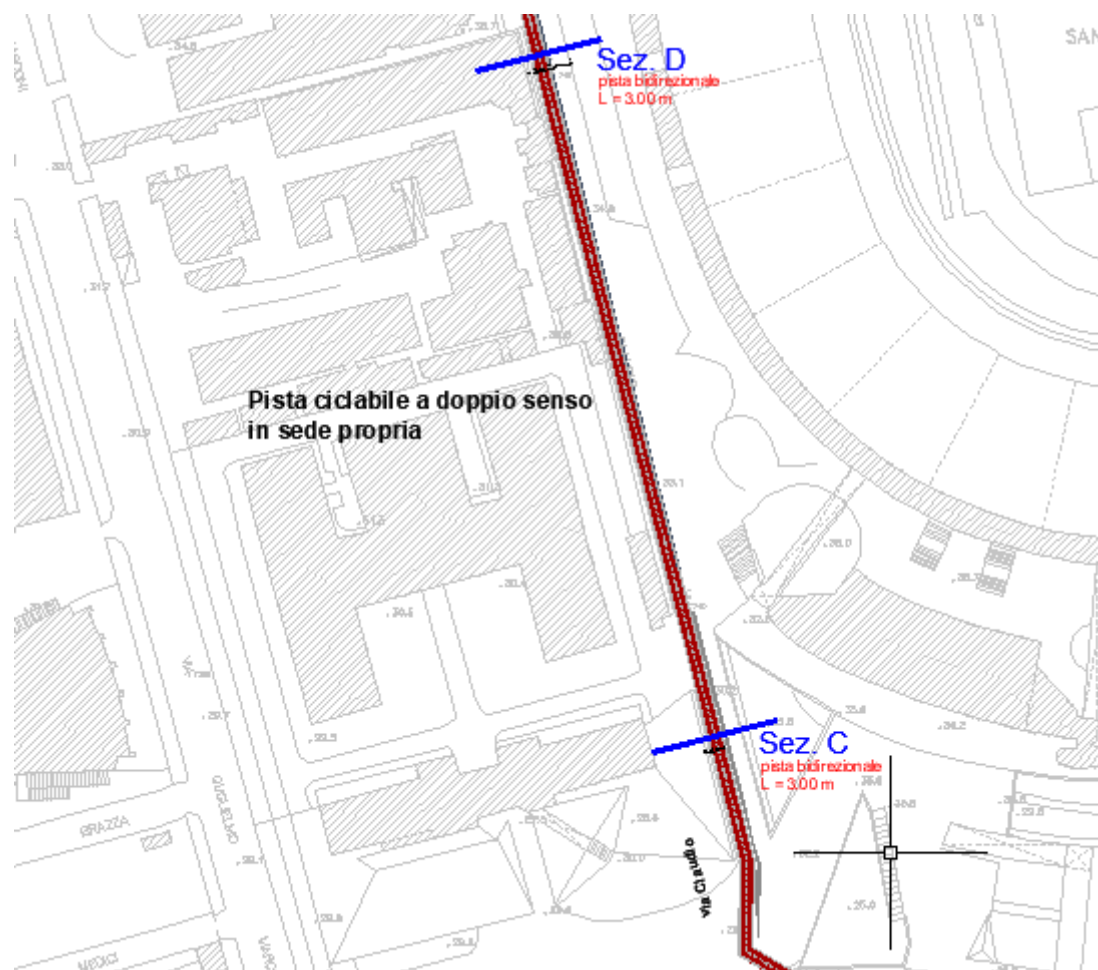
via Claudio – tratto sud, andamento planimetrico della pista ciclabile.
